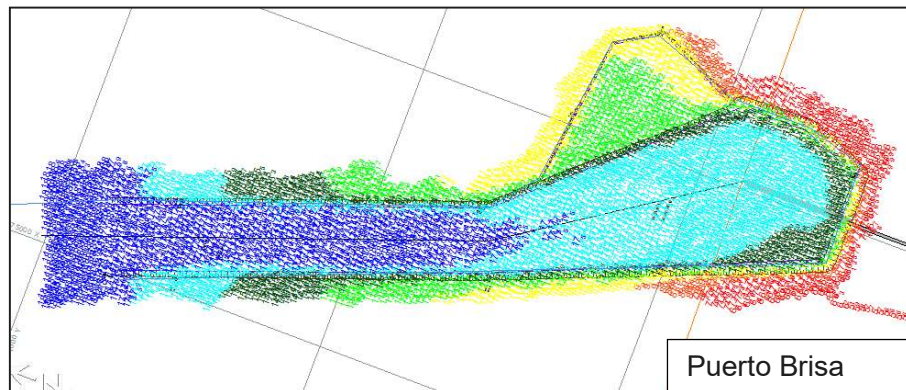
Batimetría canal de acceso Puerto Brisa
